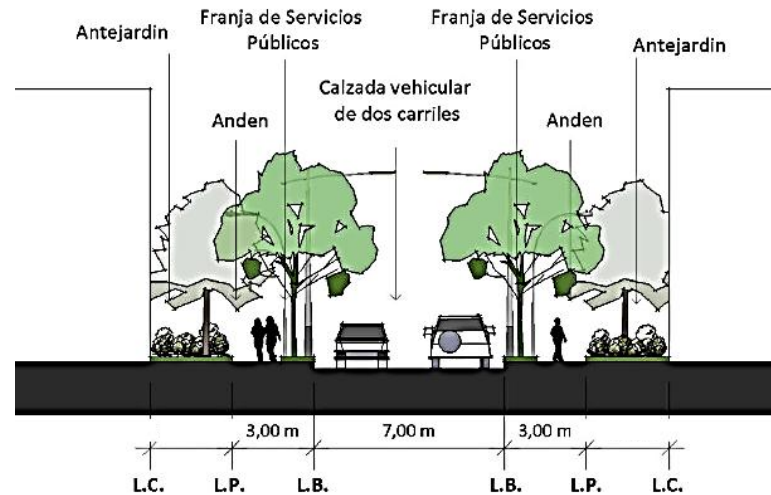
Corte Perfil Vía Local. Equipo Asesor PP.
